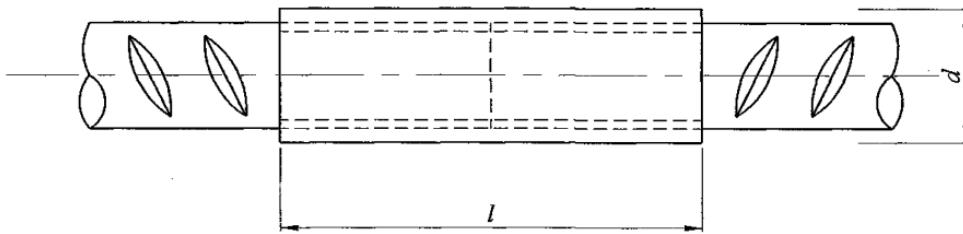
Стандартное соединение арматурных стержней с цилиндрической резьбой
